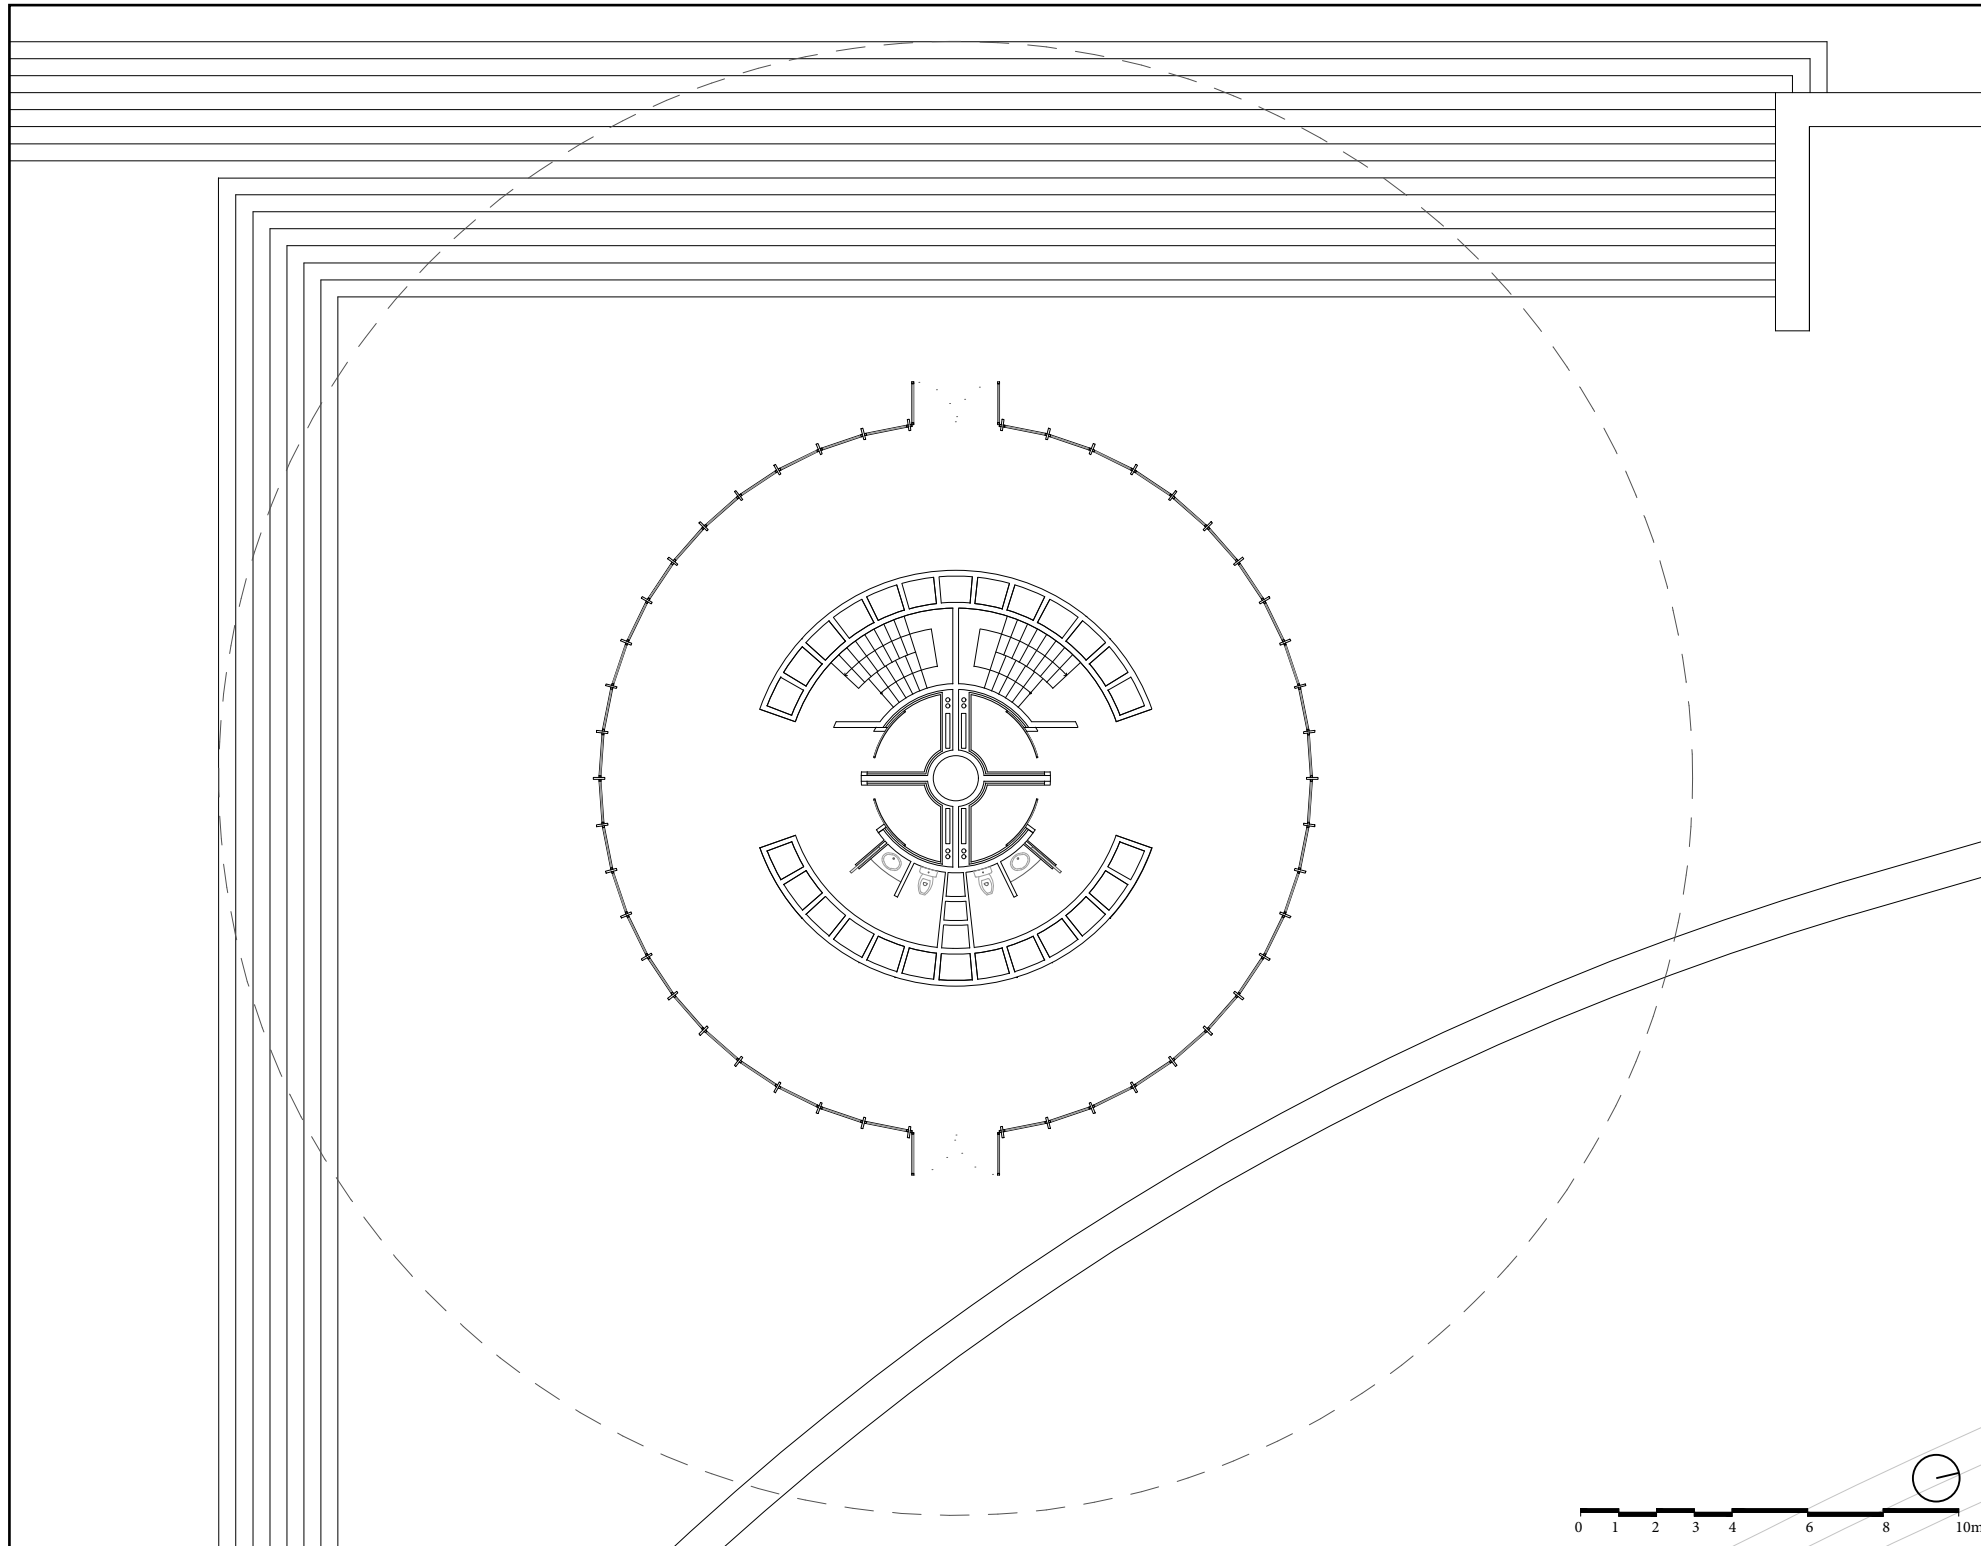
Planta Baja. Acceso. [Fuente: Autor]
